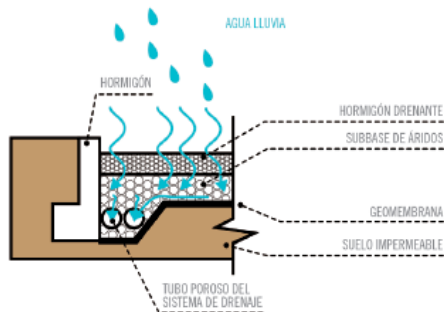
PAVIMENTO PERMEABLE CON INFILTRACIÓN
